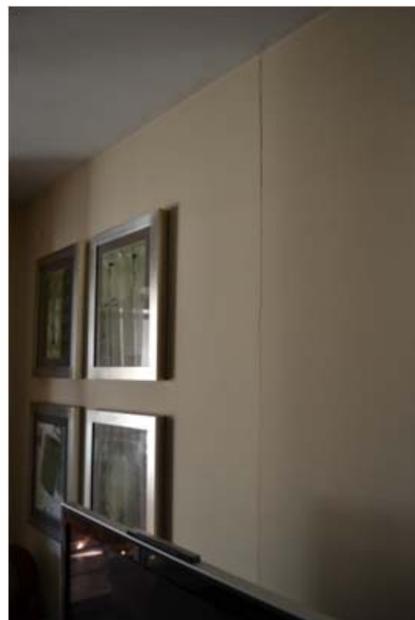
Fisuras en Paramentos Verticales de medianera entre Viviendas
